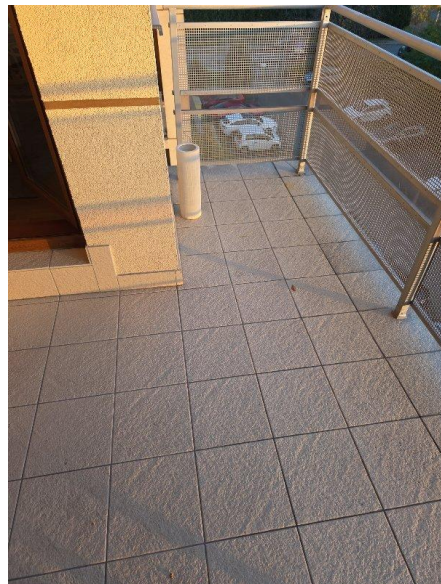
Występuje duży przeciek w miejscu przejścia pionu rury spustowej przebiegającej z dachu.
